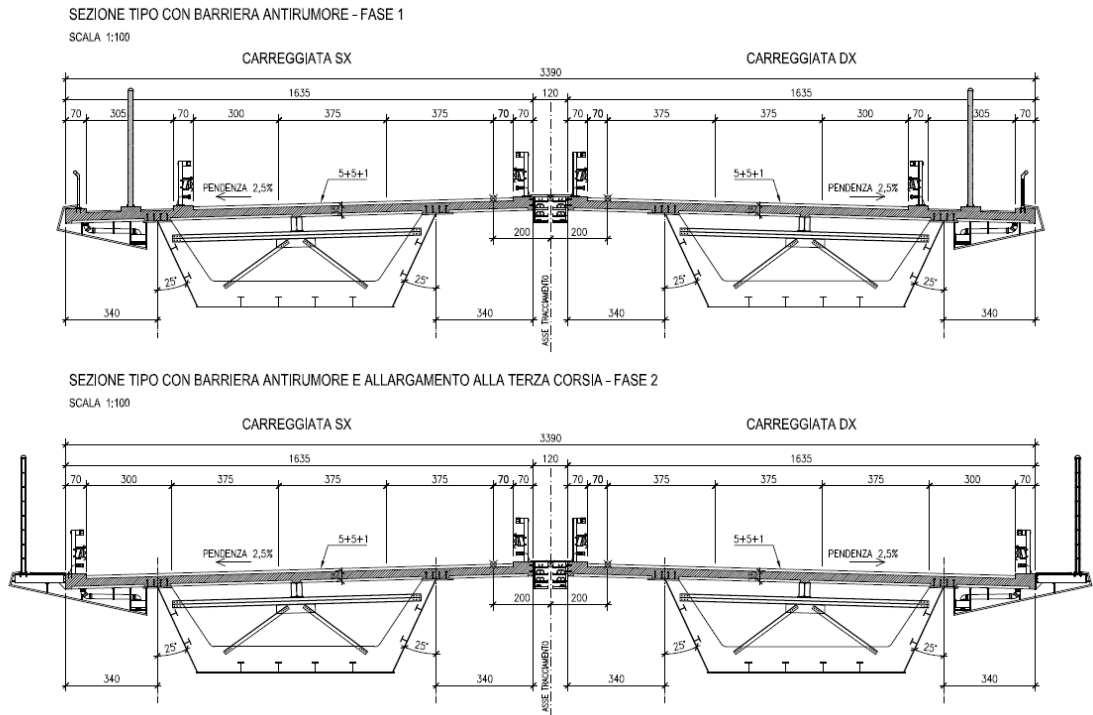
SEZIONI TIPO PER IMPALCATO MISTO ACCIAIO –CALCESTRUZZO CON BARRIERE ANTIRUMORE
